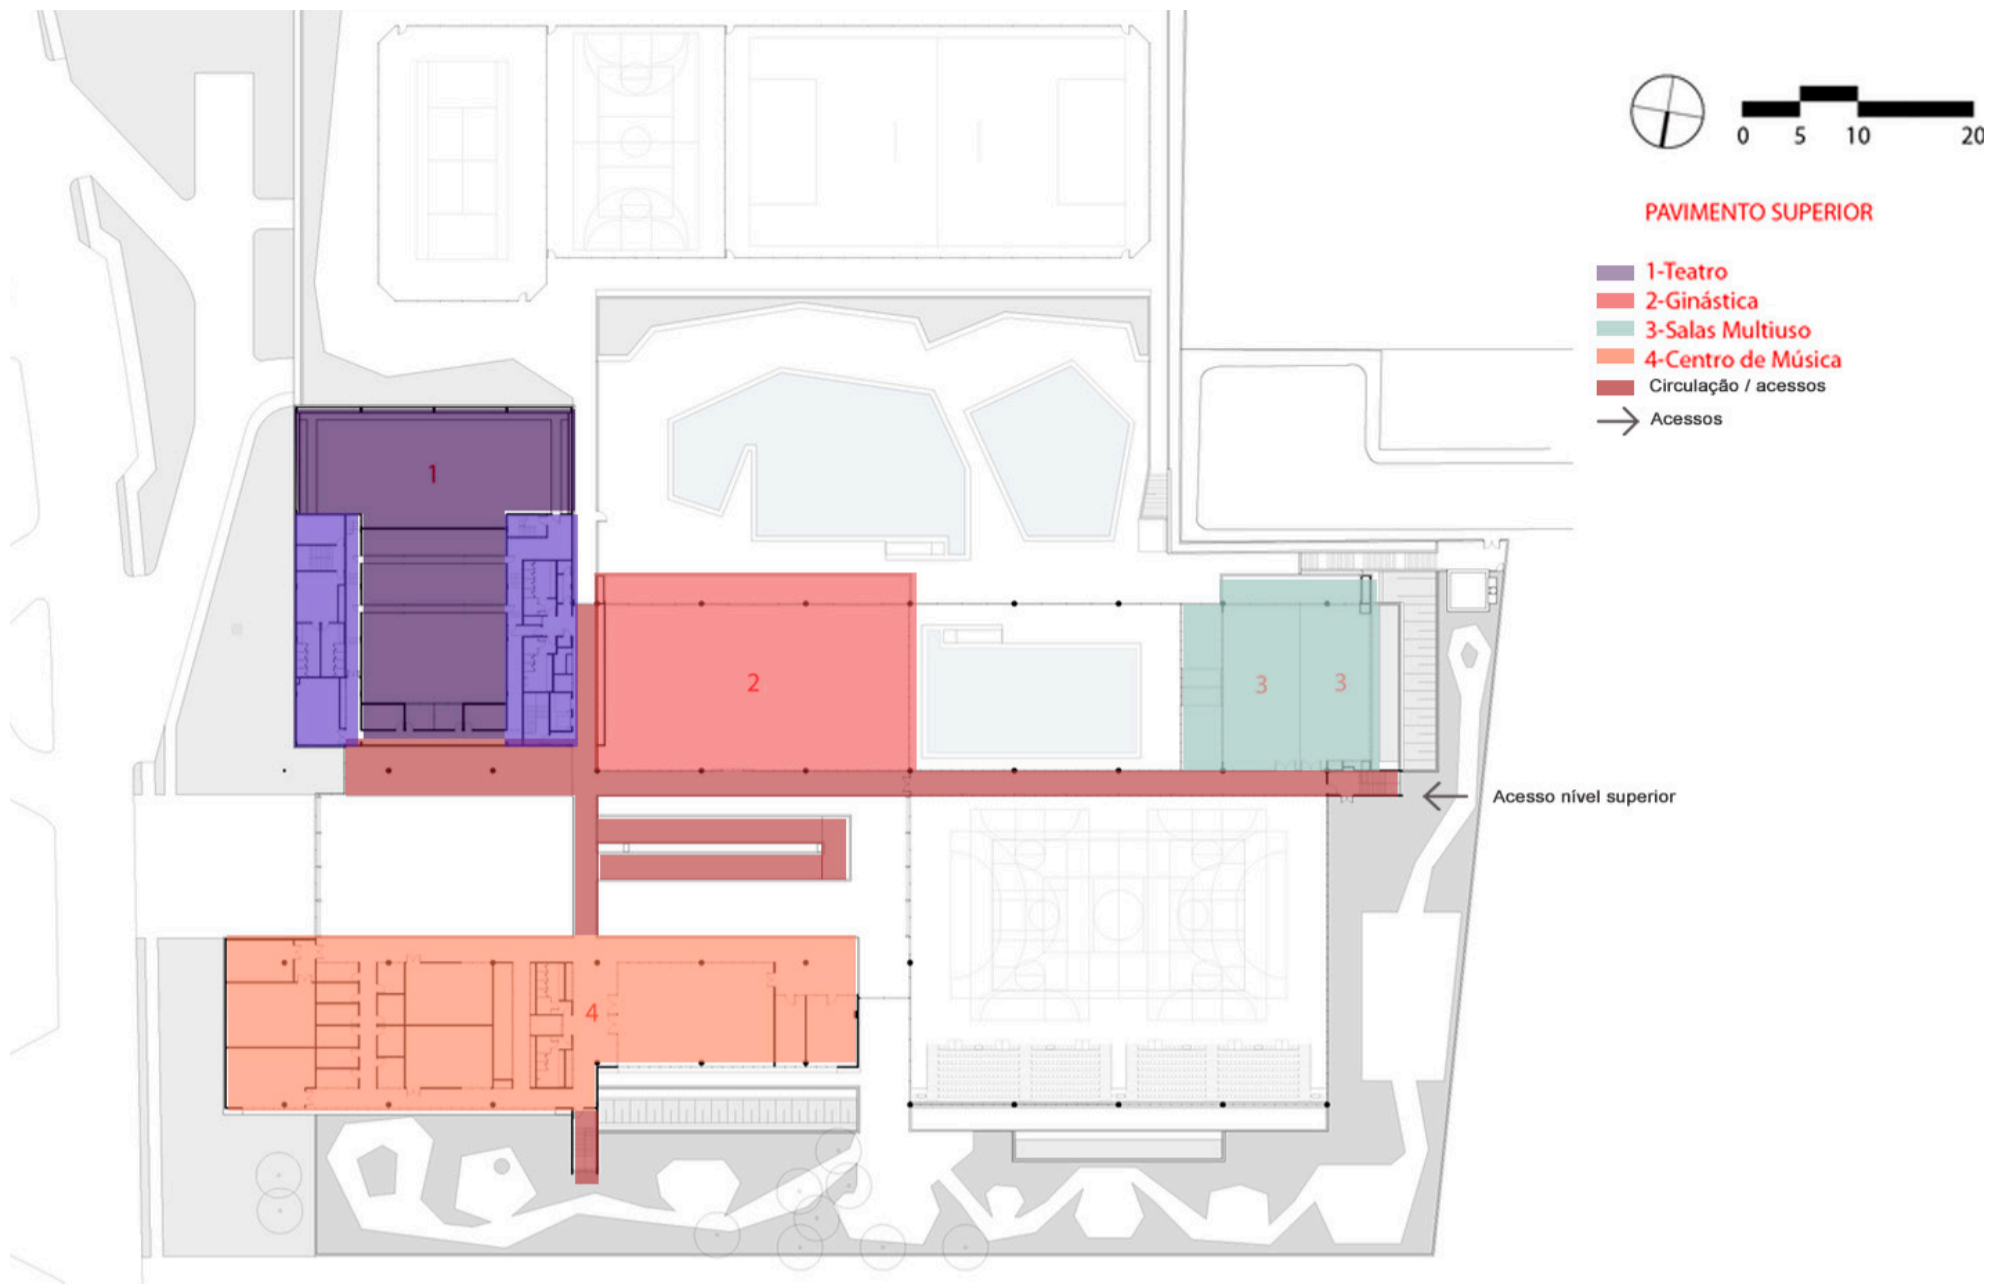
Planta nível superior SESC Guarulhos. Fonte: Autora.
